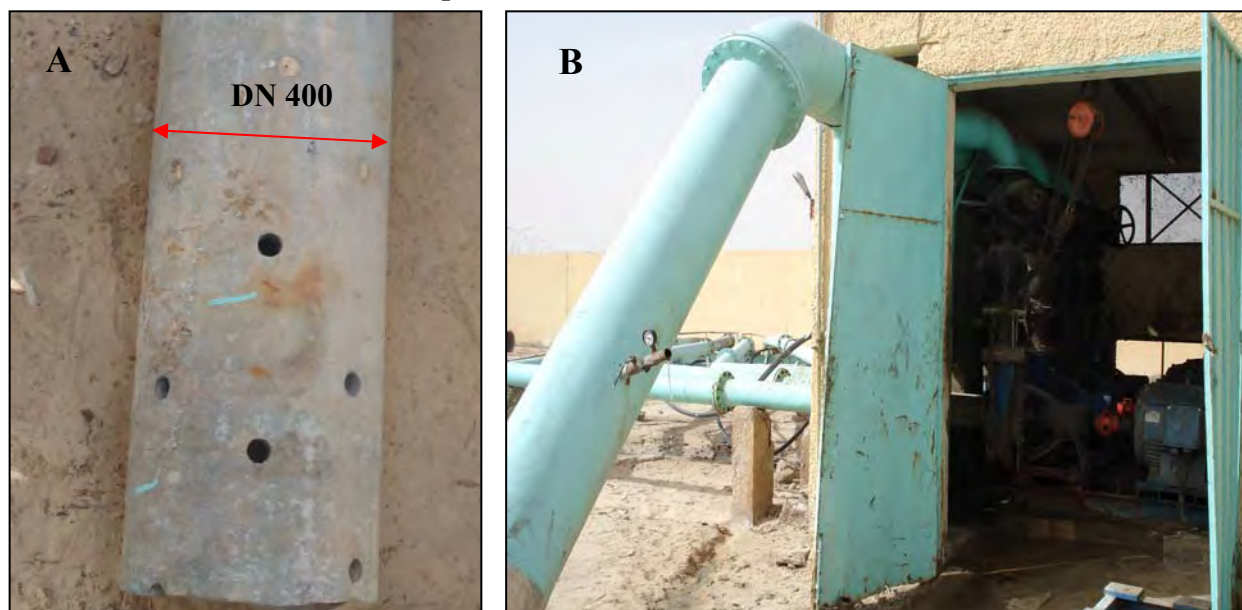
(A) Conduite d'amiante ciment utilisée dans le réseau drainage horizontal. (B) la station de pompage des eaux de drainage avant 2012.
